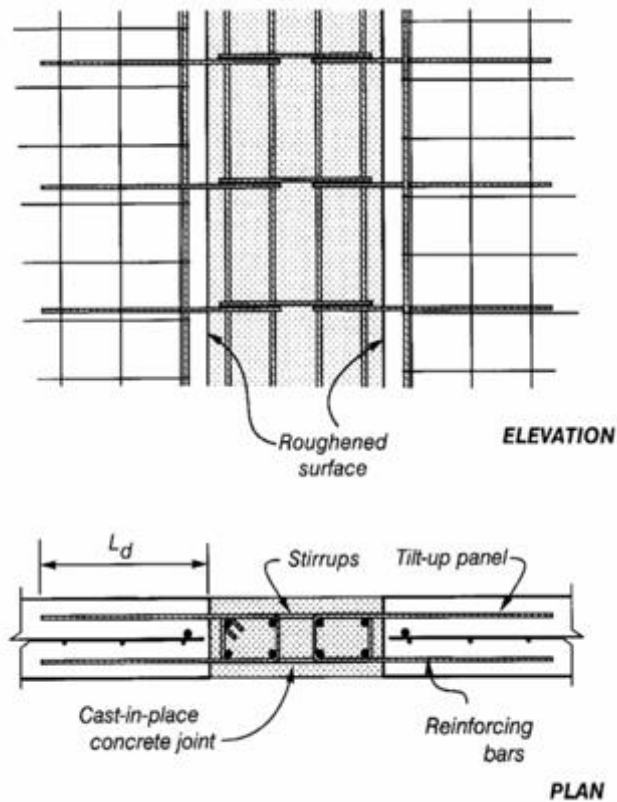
Empalmes con estribos de caída libre (fib, 2003).
